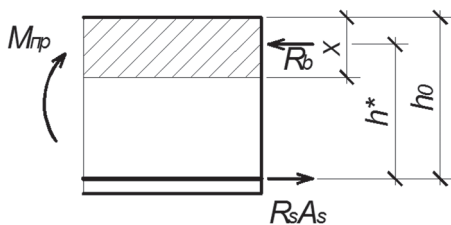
Схема для определения предельного изгибающего момента плитной части ленточного железобетонного фундамента
